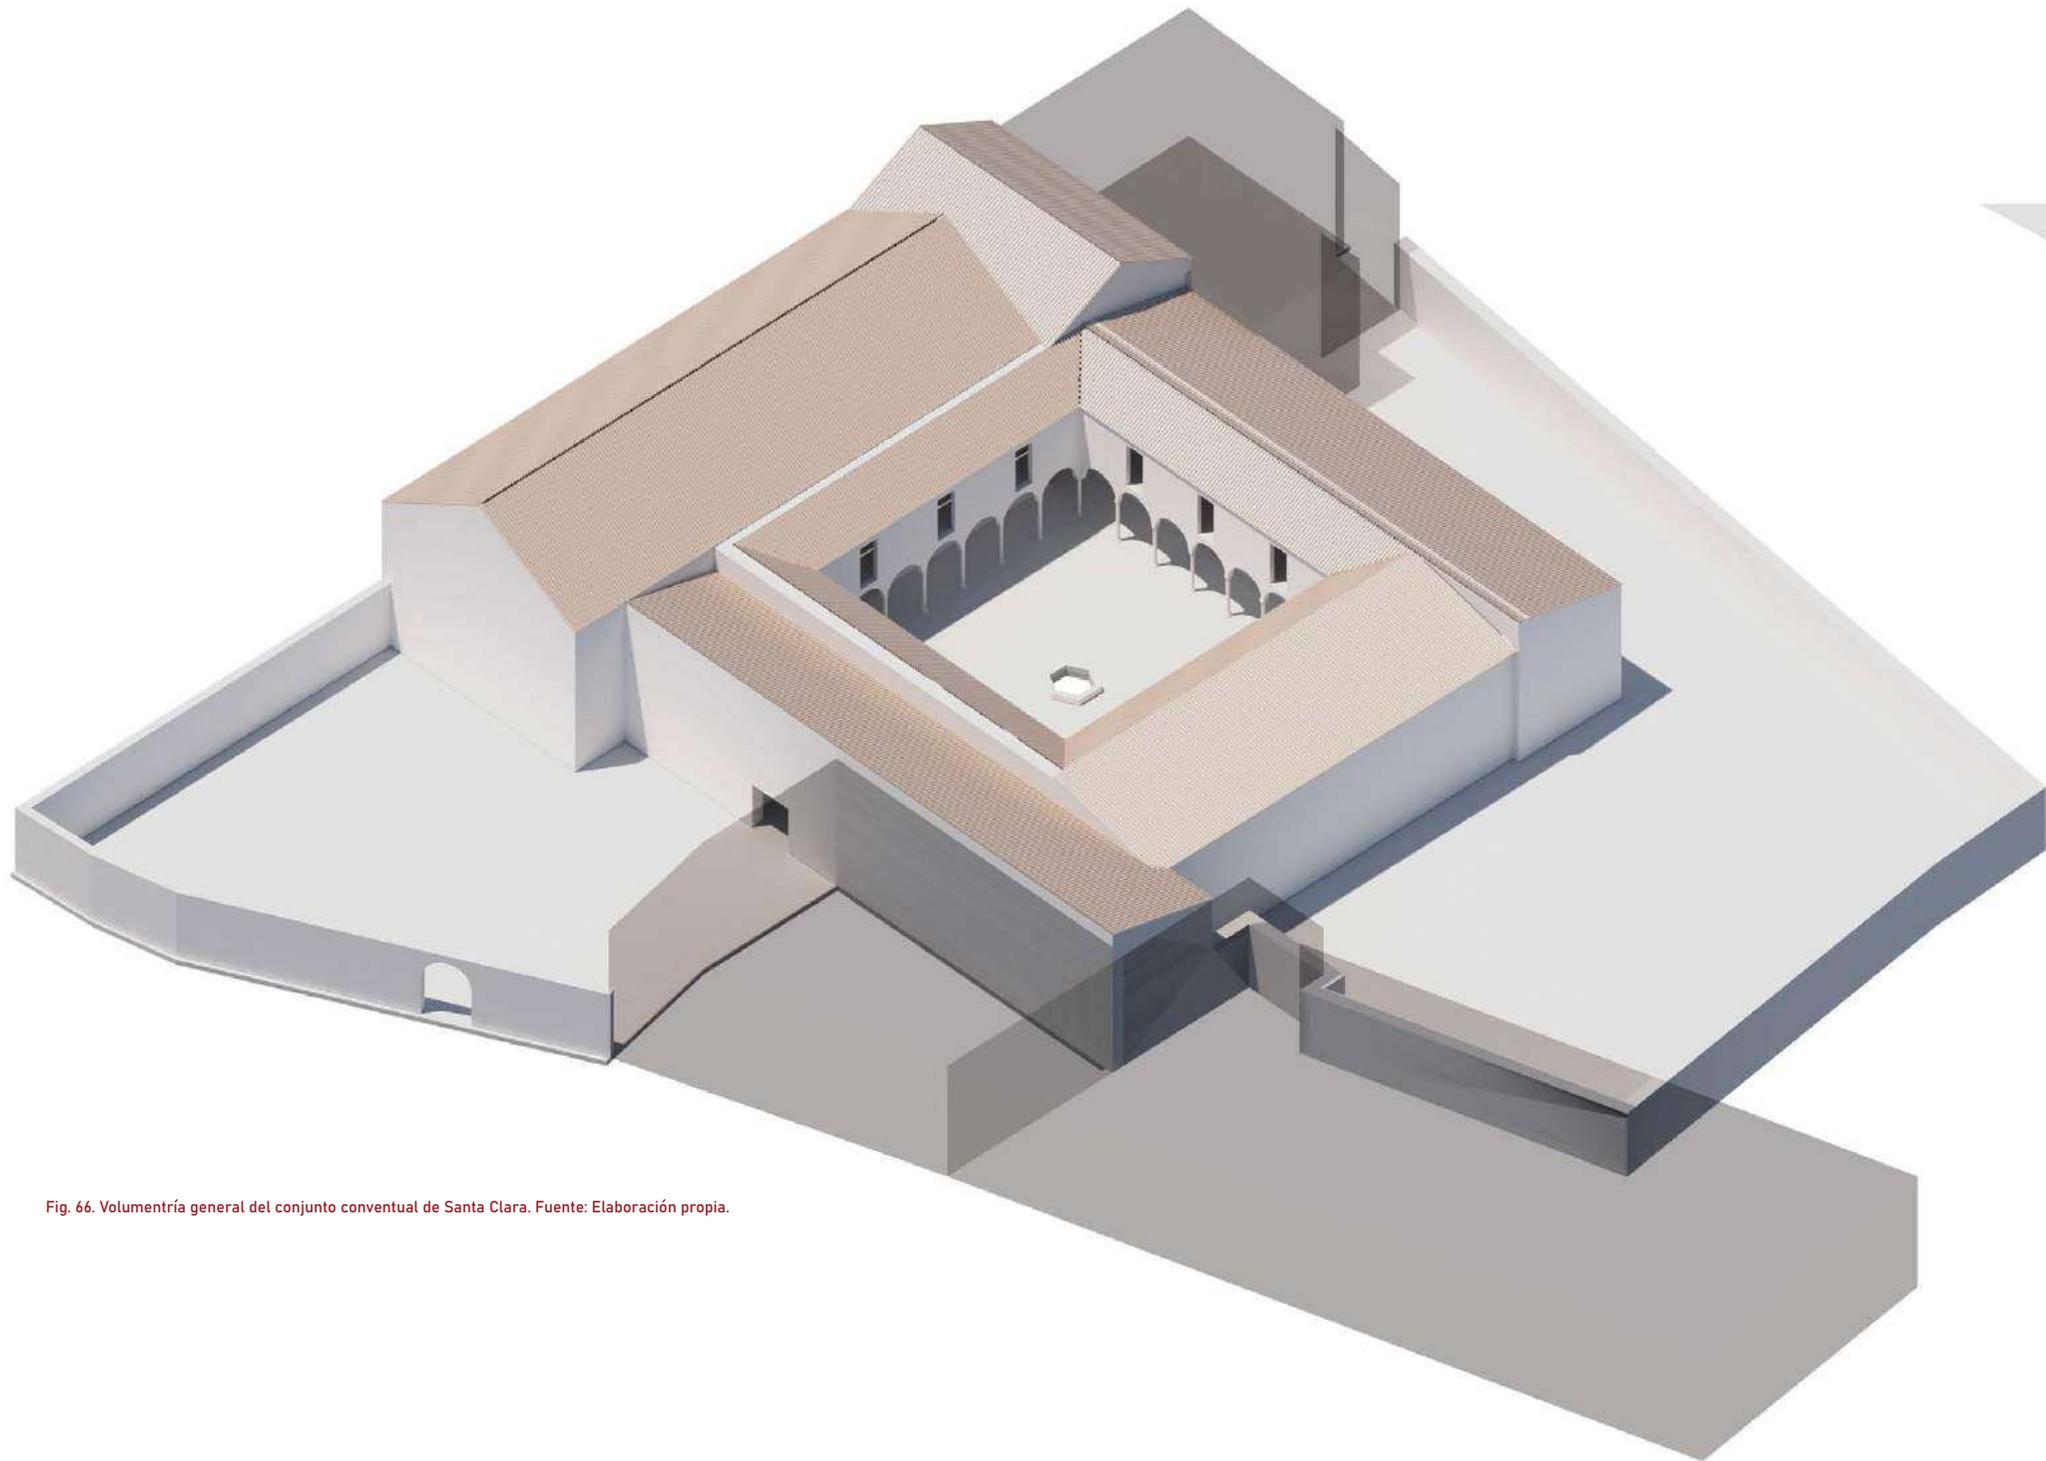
Volumentría general del conjunto conventual de Santa Clara. Fuente: Elaboración propia.
